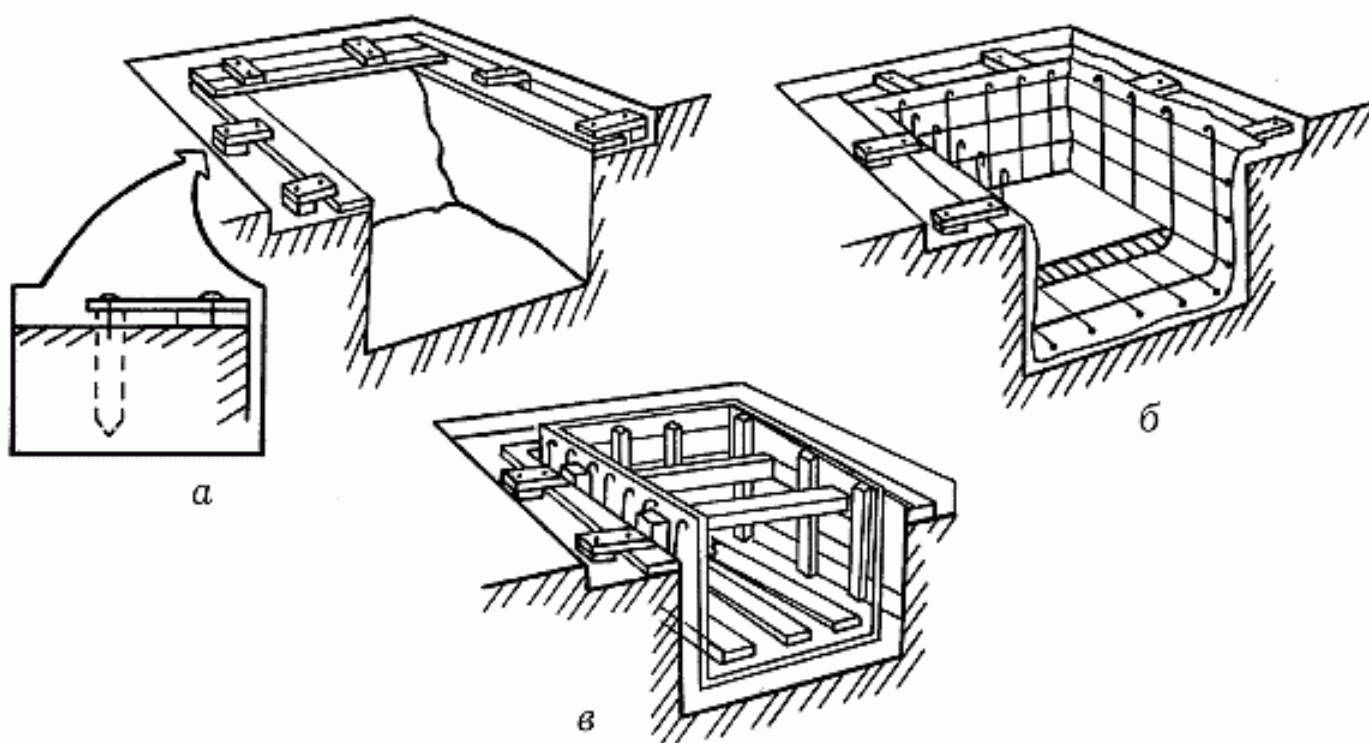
Бетонирование купального бассейна прямоугольной формы: 1 – рытье котлована и установка досок внешнего контура; 2 – установка арматуры и бетонирование дна; 3 – установка опалубки и бетонирование стенок
